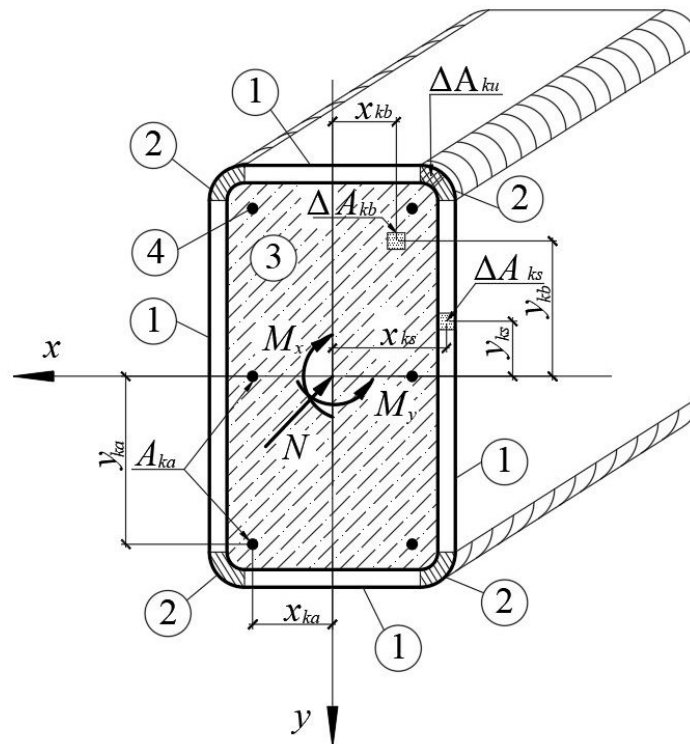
Нагружение трубобетонного элемента прямоугольного сечения: 1 – плоские участки трубы, 2 – участкигиба, 3 – бетон, 4 – арматурные стержни
